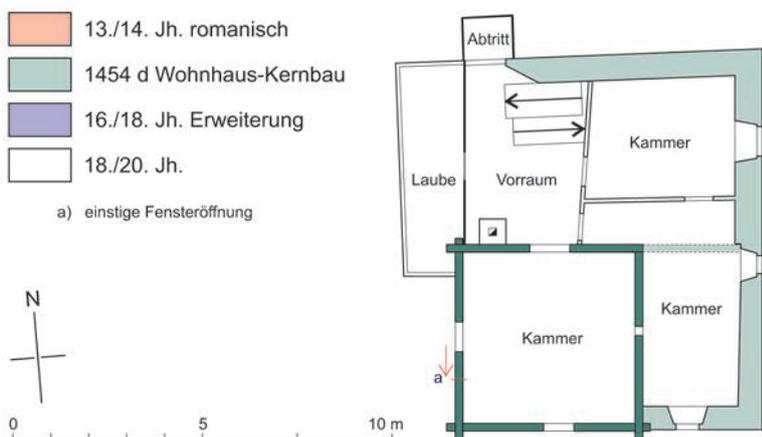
Grundriss Obergeschoss. M. 1:200.
